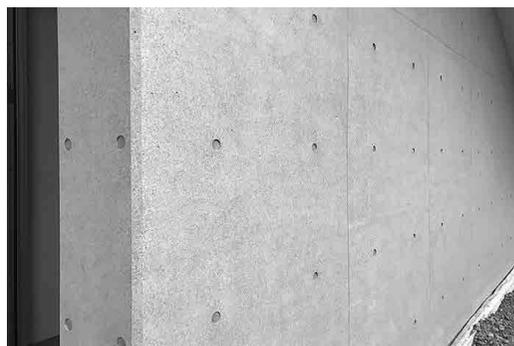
医療施設外壁 面積 3,000m<sup>2</sup> 2021 年 施工
